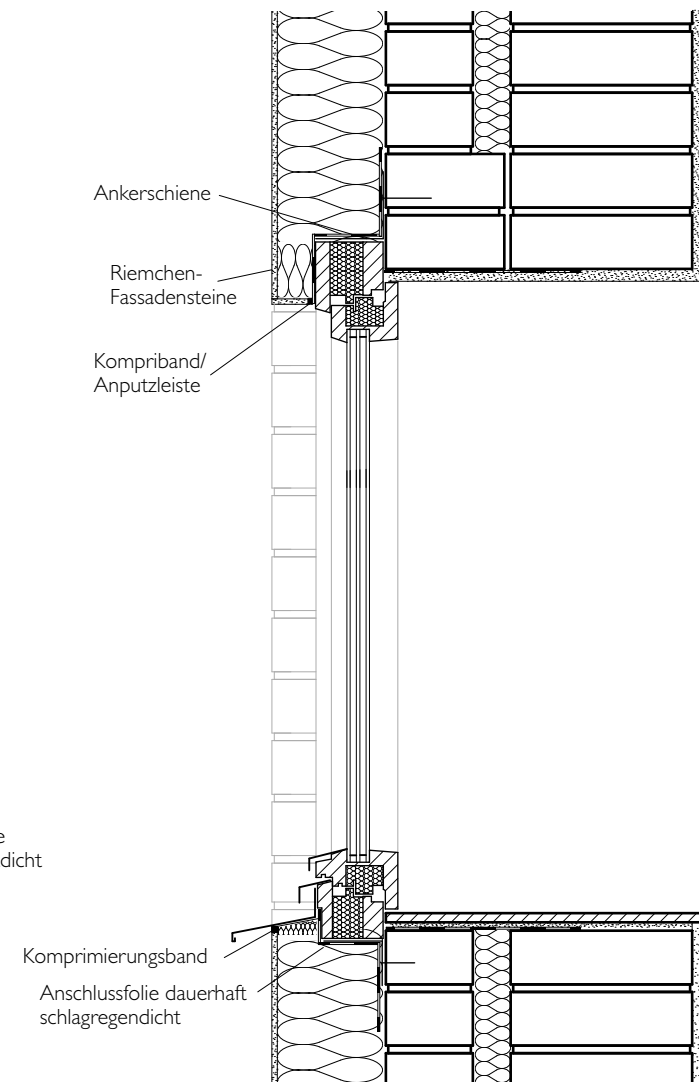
Fensterdetail, Befestigung am Mauerwerk mit Ankerschiene, M 1:10
